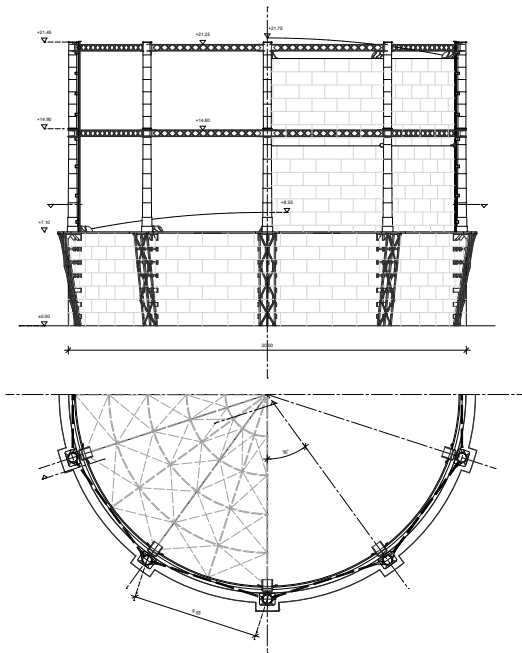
Gasbehälter V, Venedig San Francesco della Vigna, Grundriss/Ansicht M 1:200
